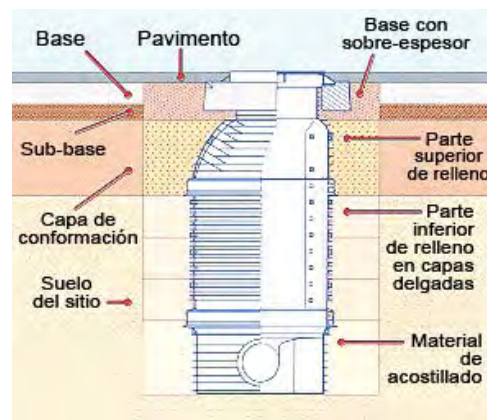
Alzado y corte de pozo de 1.00 m de diámetro para profundidades de hasta 5.00 m.
